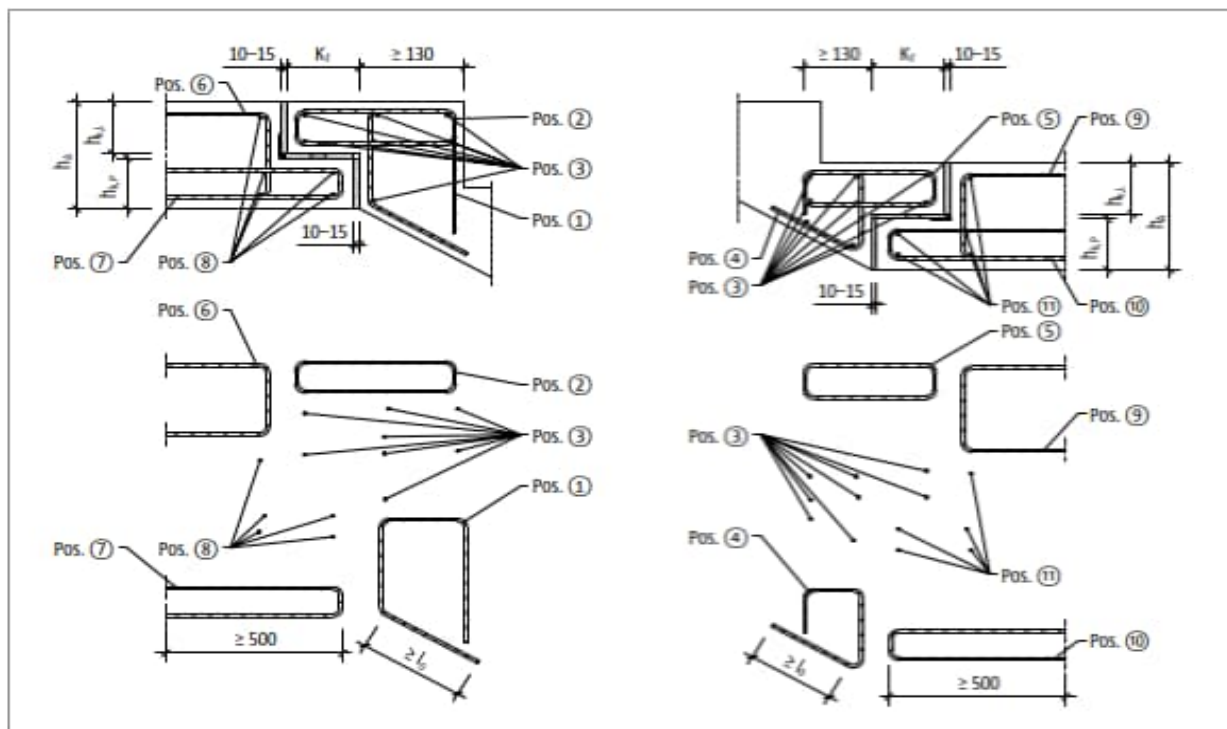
Schöck Tronsole® Typ F: Bauseitige Bewehrung bei bündigem Anschluss
